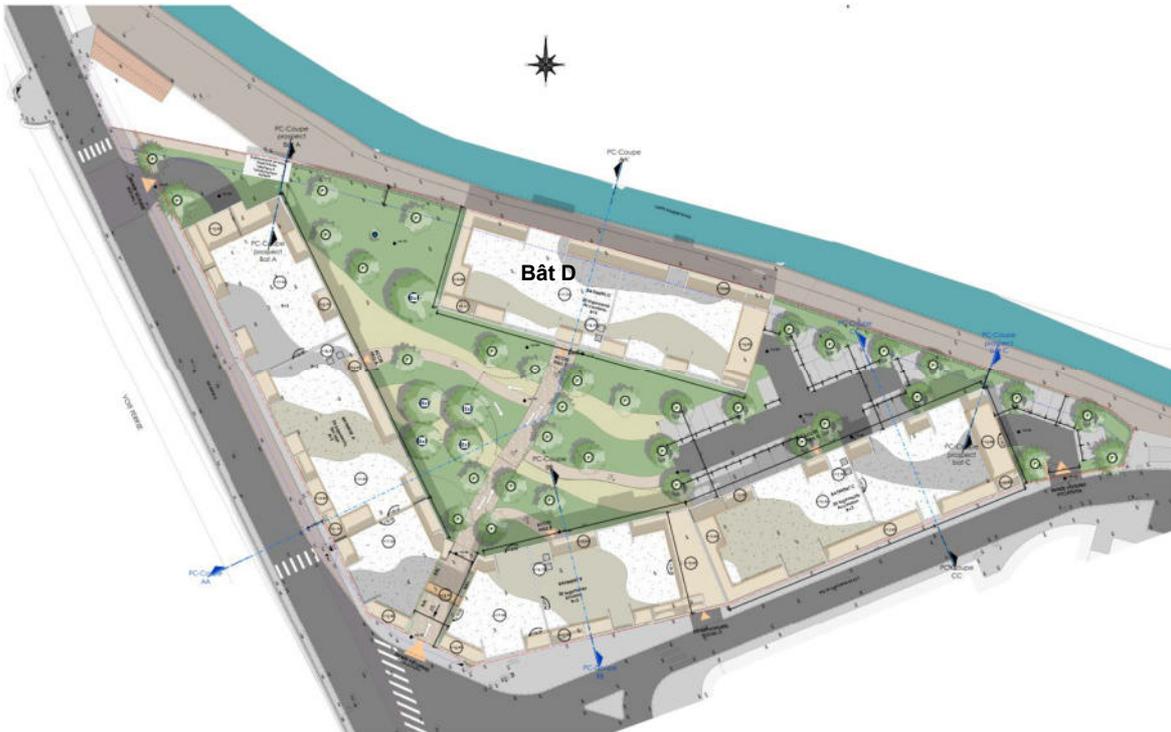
plan des stationnements dans la nouvelle configuration du projet d'aménagement (Source : Atelier empreinte – janvier 2021)
